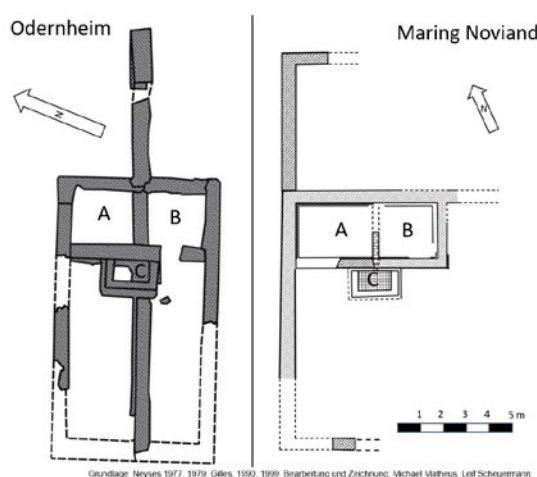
Grundrisse Odernheim, Marhing Noviant
